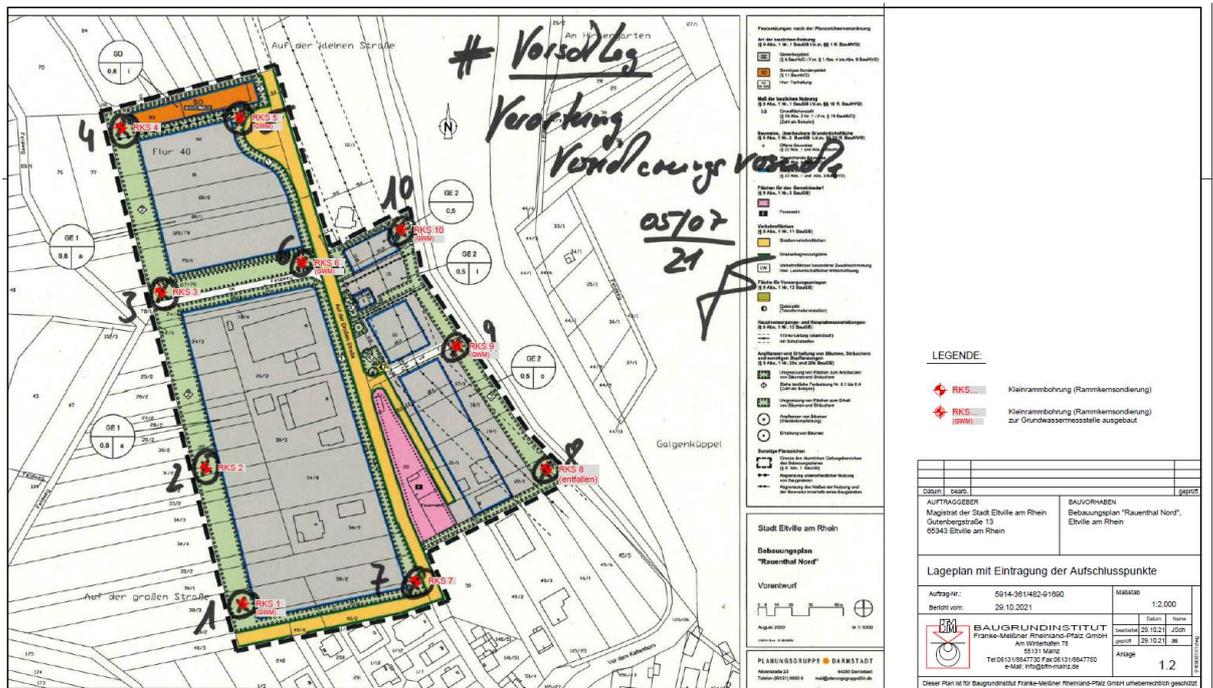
Lageplan mit Eintragung der Aufschlusspunkte, Baugrundinstitut Franke-Meißner 2021
